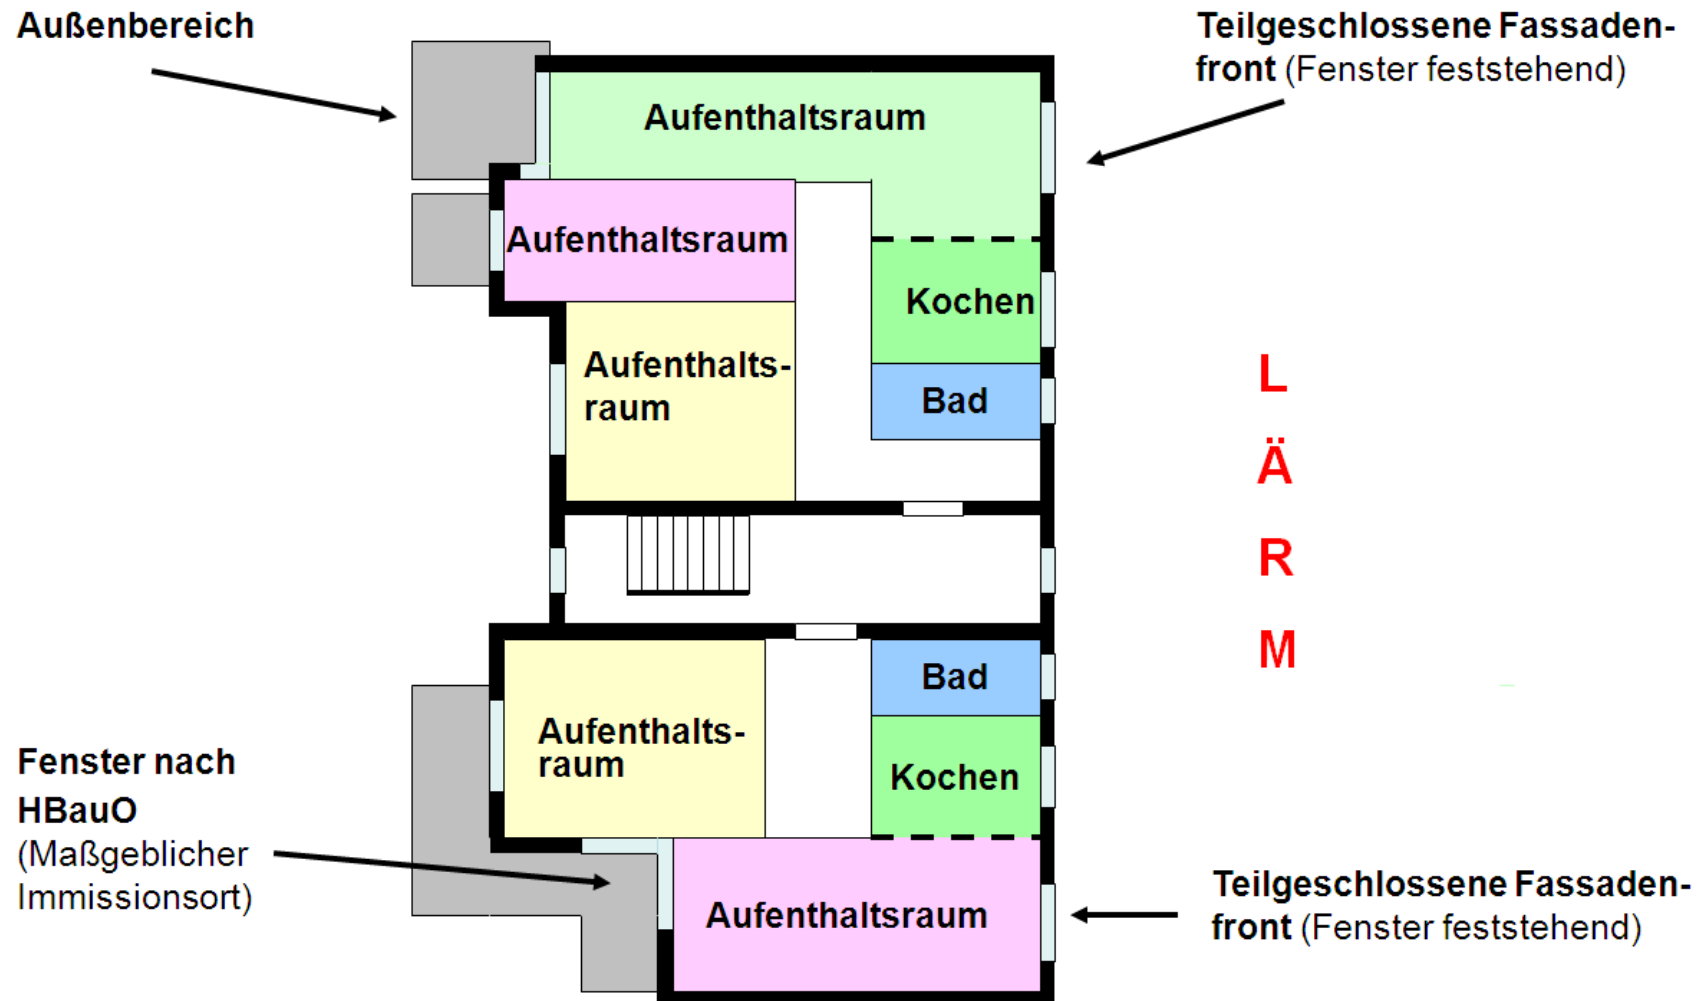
Funktionsskizze „geschlossene bzw. teilgeschlossene Fassadenfront“
